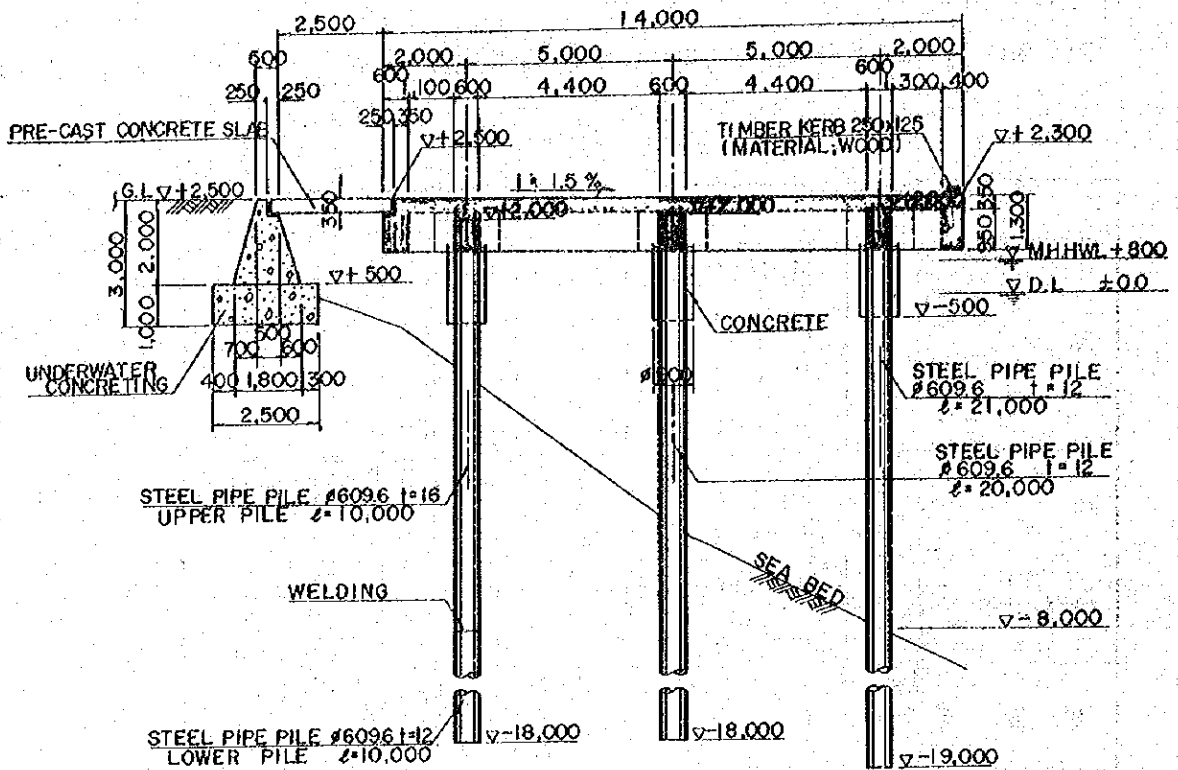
6 - 2(2) MOORING SECTION CONNECTION BRIDGE
